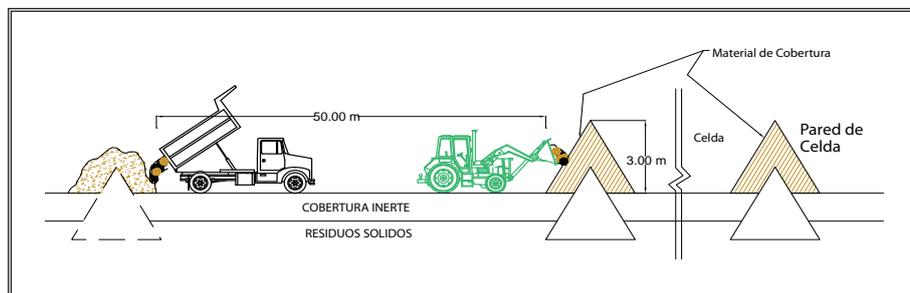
Diagrama de la construcción de las paredes laterales de las celdas de disposición final.
